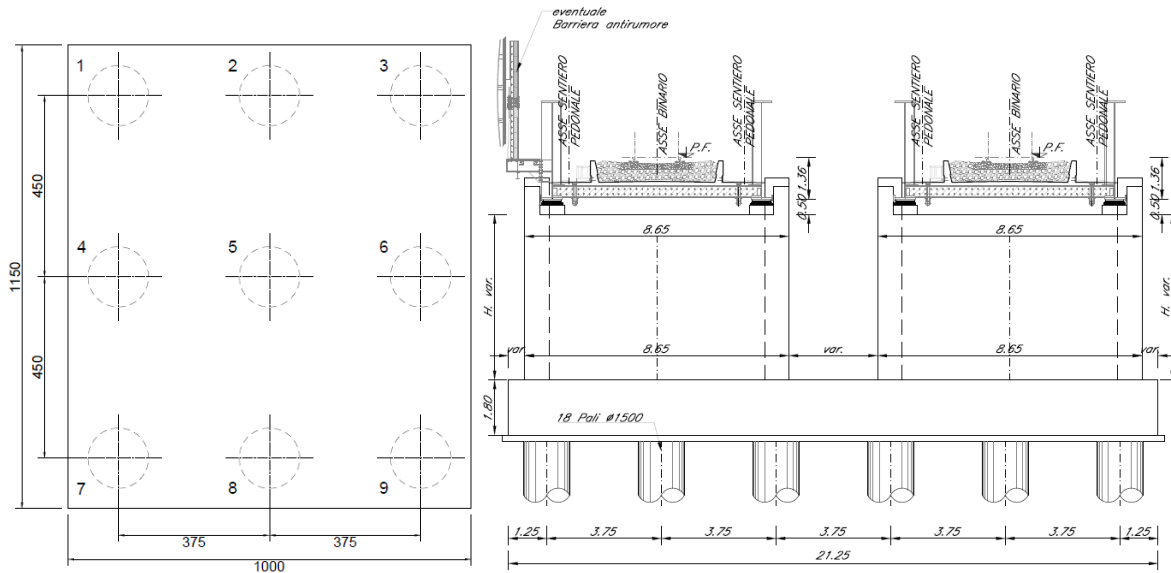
stralcio della carpenteria spalla e fondazione su n°12 pali
